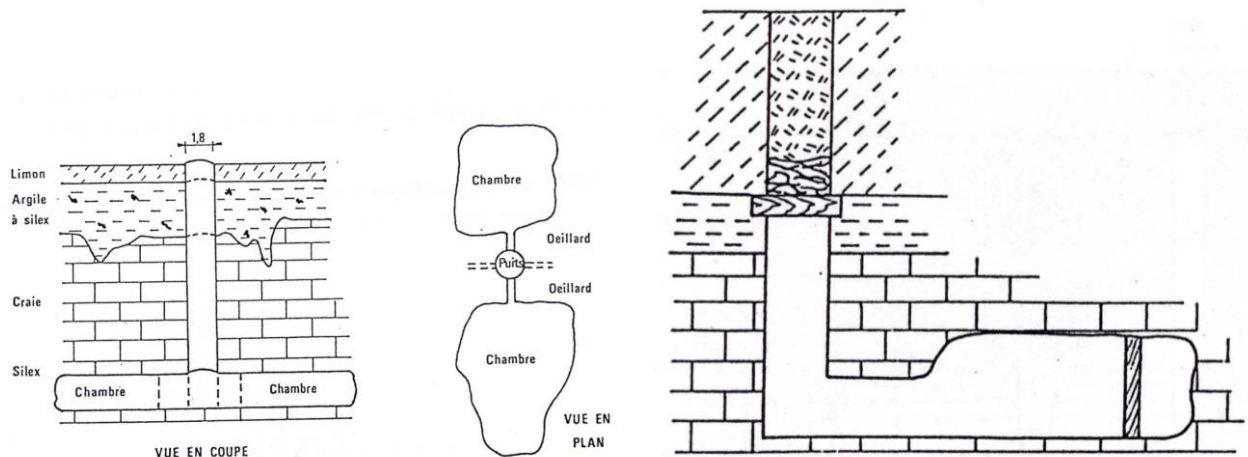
Vues en coupe et en plan d'une marnière (source ALISE)
